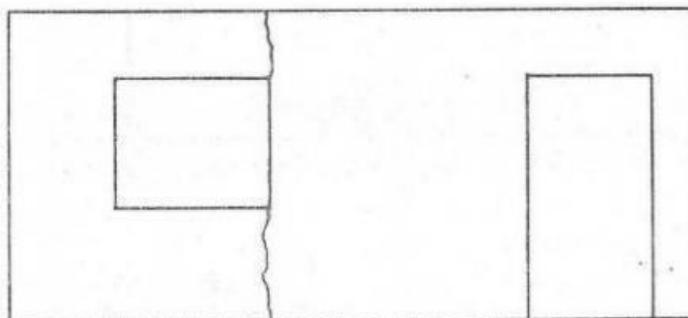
Fissuração ocasionada por Movimentação Térmica da Laje de Cobertura.
